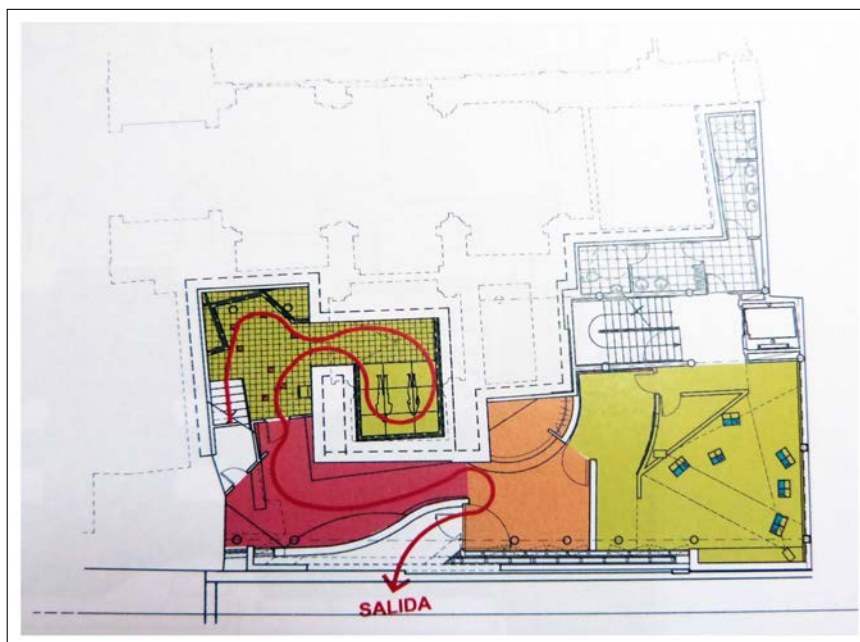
Plano de la planta baja con el itinerario de la visita
